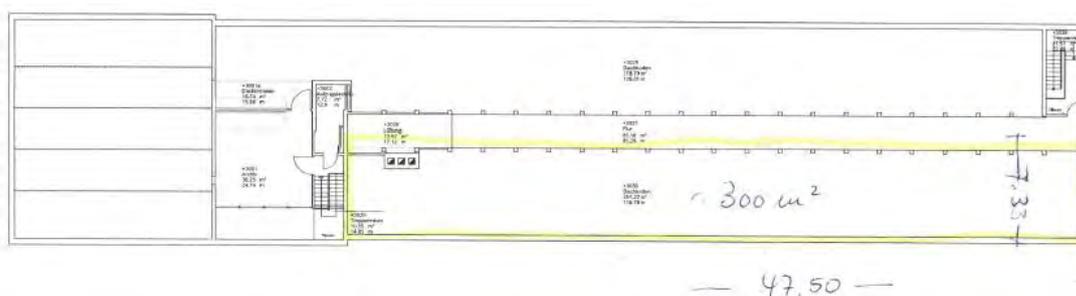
Grundriss des Dachs, Lage und Fläche der PV-Anlage „Biegenstraße 12“
